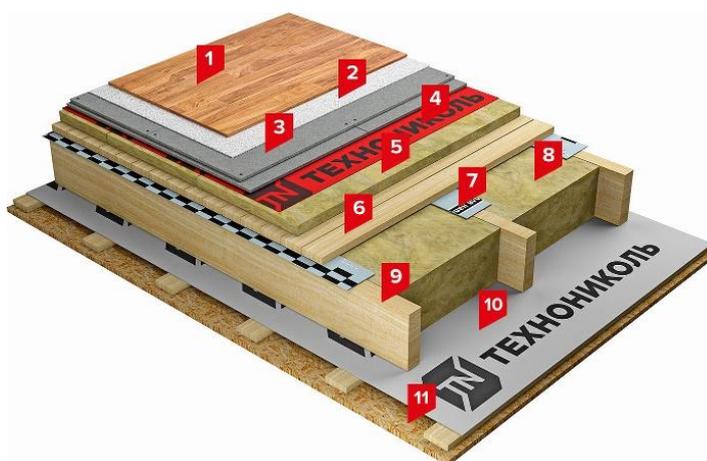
Конструктивное решение междуэтажных перекрытий по деревянным балкам:
